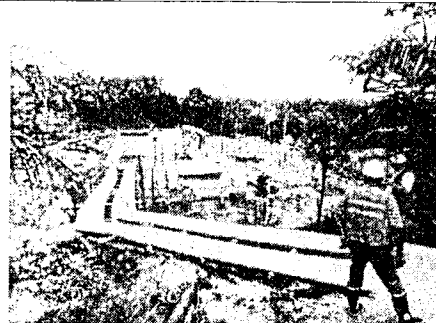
Construcción planta de tratamiento de aguas residuales – PTA
